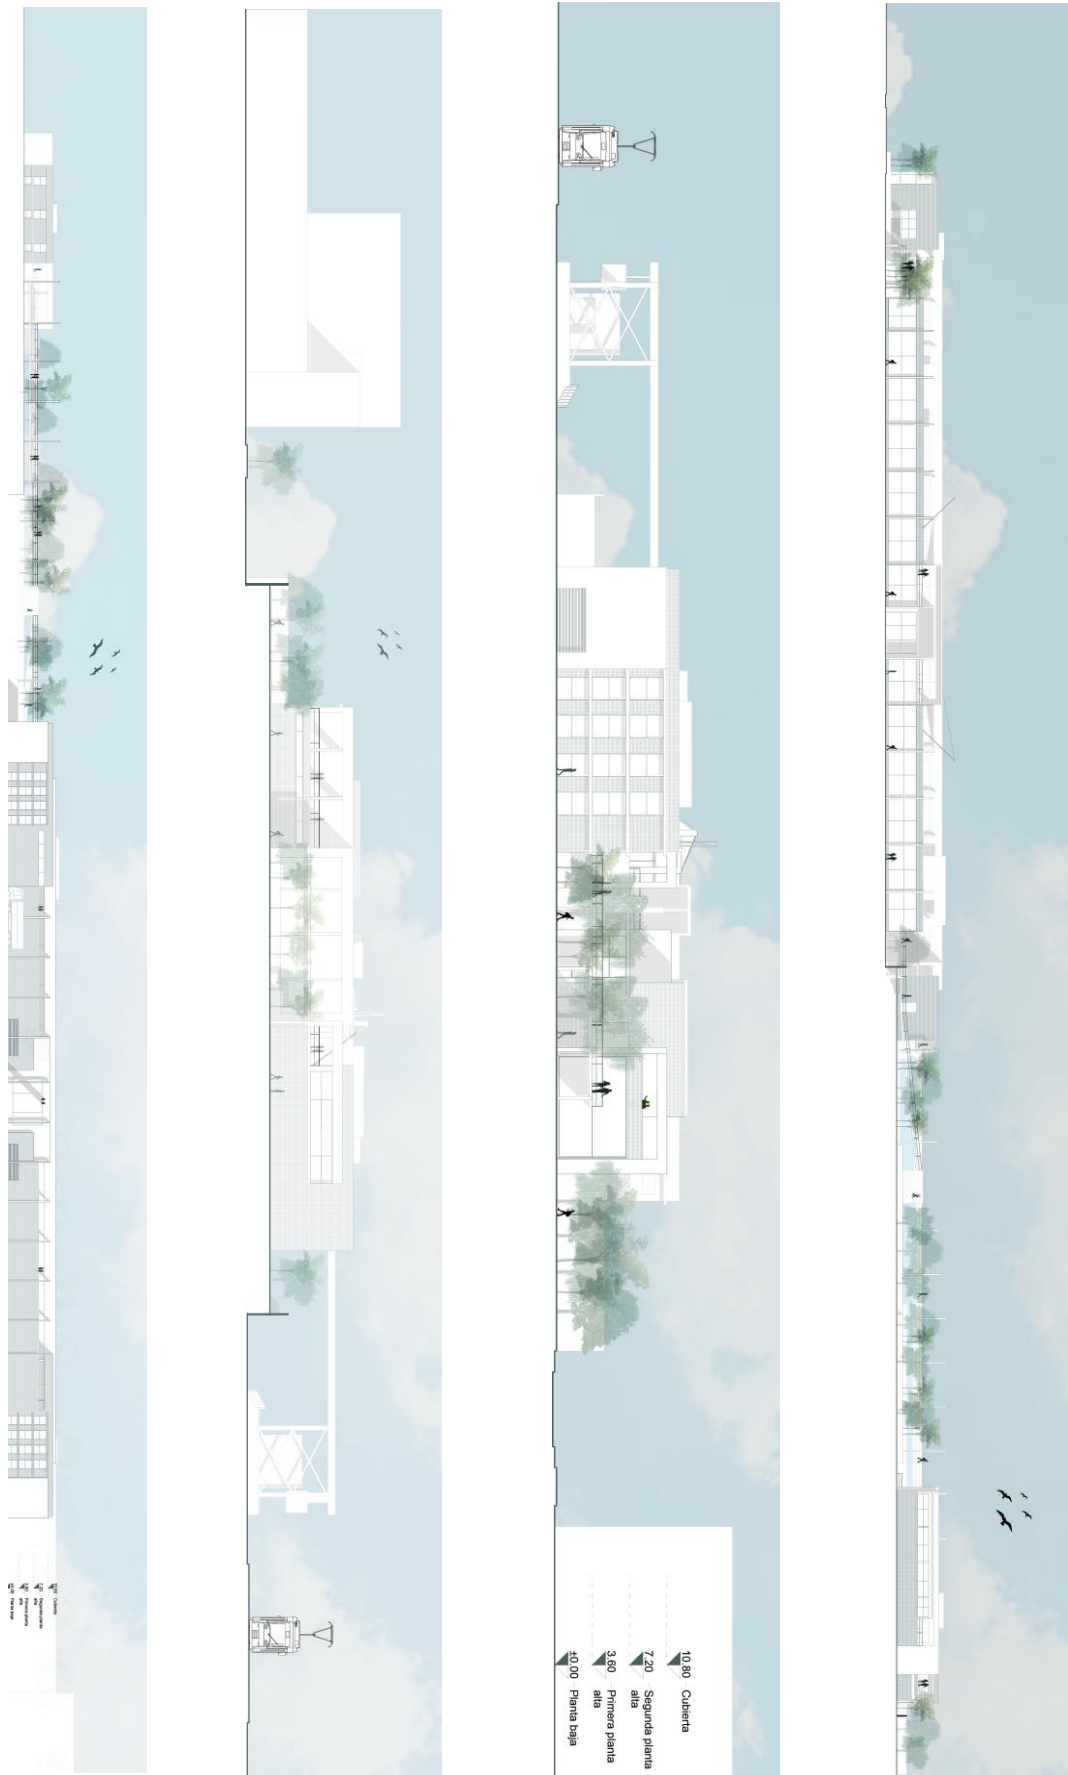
Fachadas Arquitectónicas. Elaboración propia.
